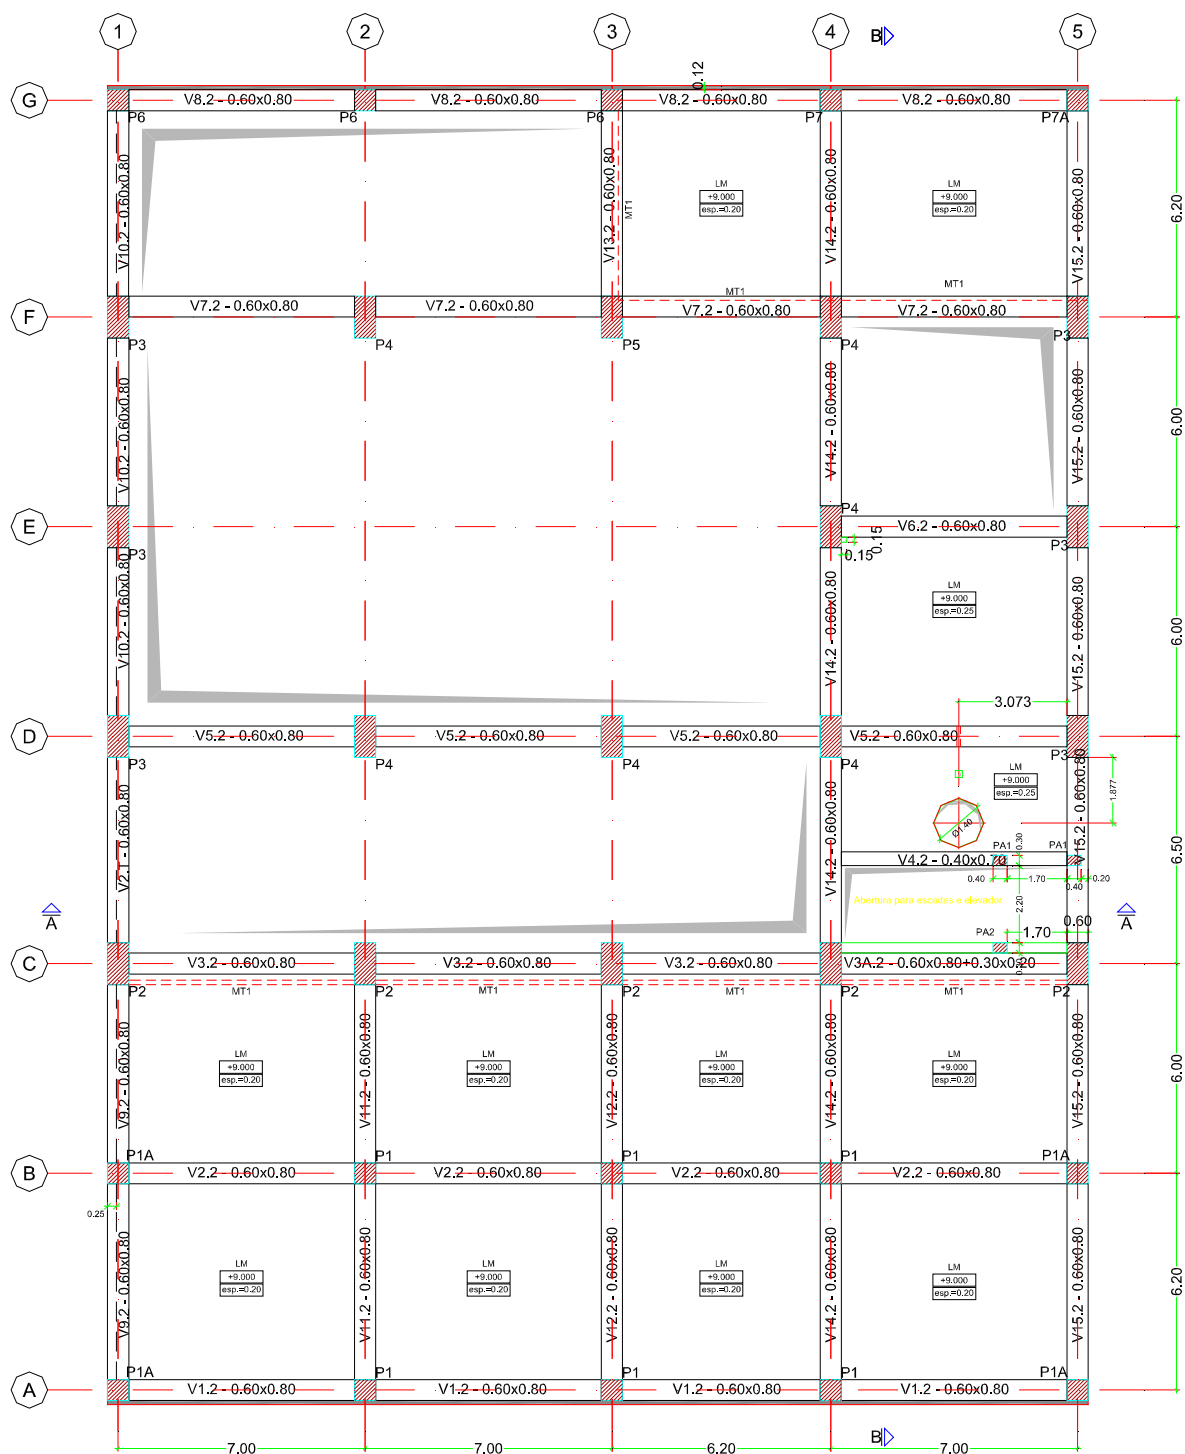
Planta estrutural à cota +9,00 m.
